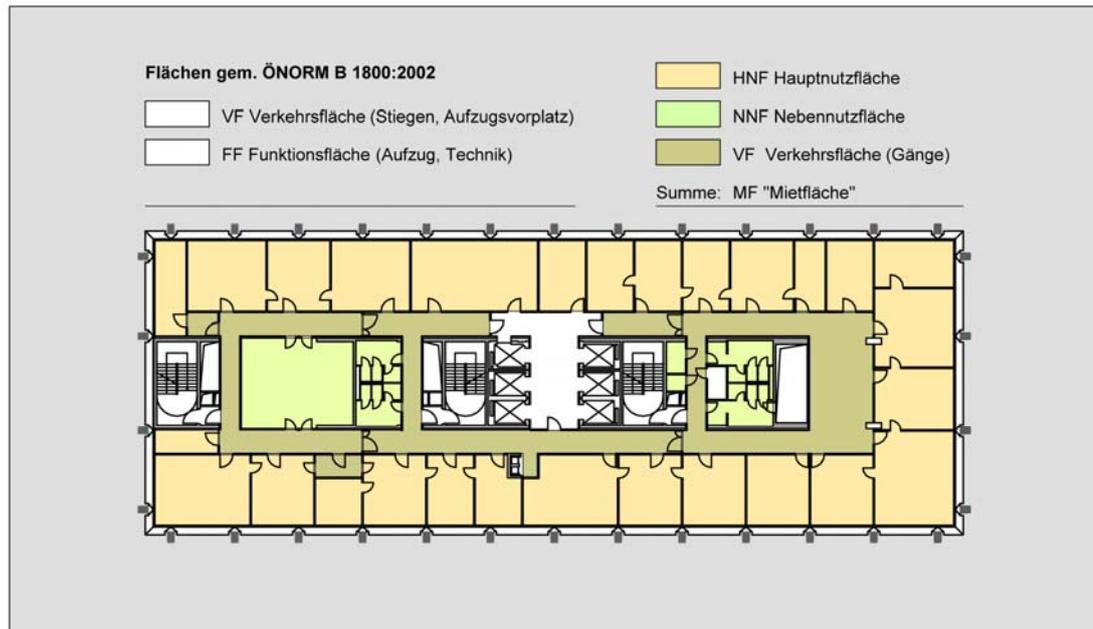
Übersicht Grundriss Regelgeschoss, ohne Maßstab<sup>68</sup>
